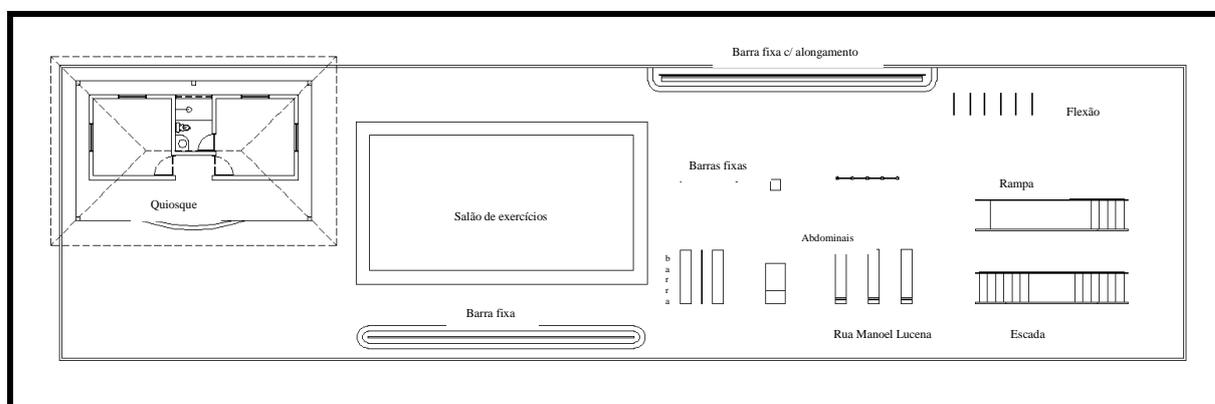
Planta Baixa de Equipamentos de exercícios físicos.
